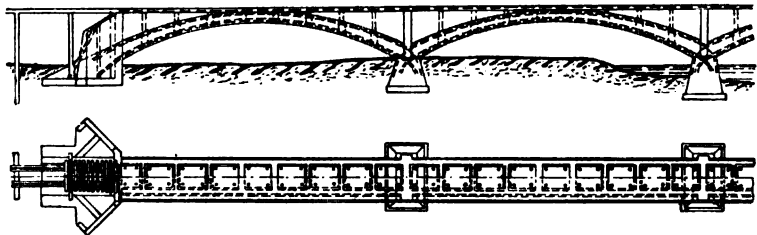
Grundriß und Längsschnitt der Brücke bei Belvedere.
